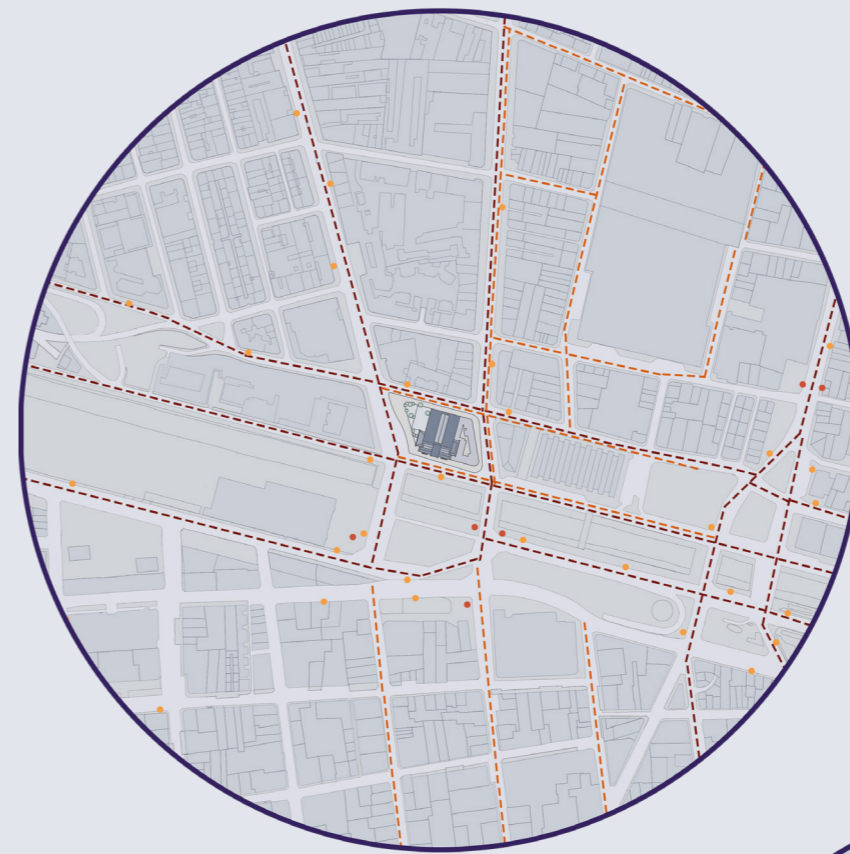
Plano Emplazamiento, esc. 1:5000. Fuente: Elaboración propia
